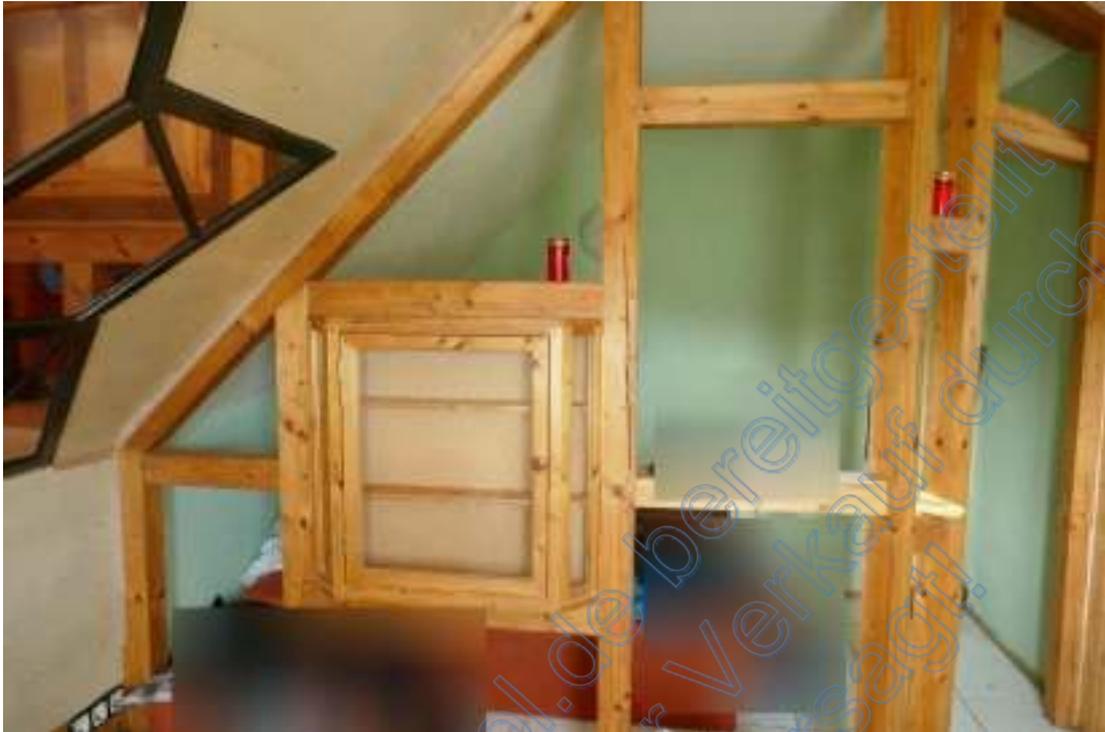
, Dachgeschoss (DG), Wohnhaus, beispielhaft ein Wohnraum
